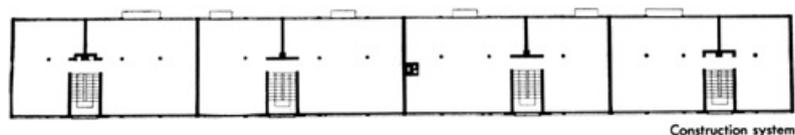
| Bloque lineal Weissenhof. Planta del Sistema constructivo, 1927. Fuente: Johnson (1947:48).
